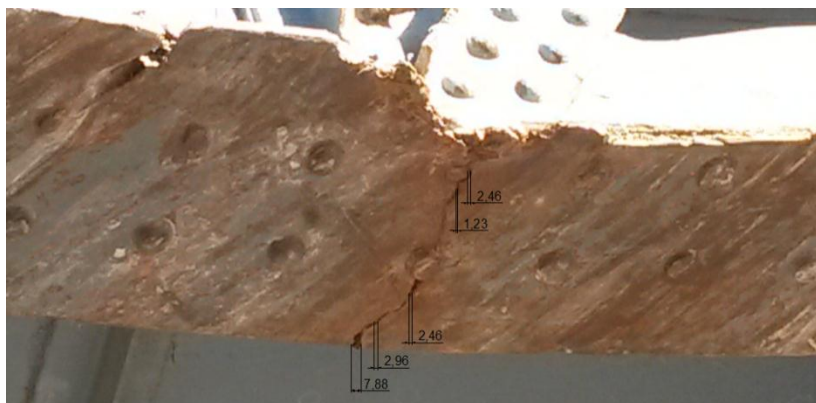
Fissure d'une largeur entre 1,23 et 7,88 mm sur la semelle inferieure de la poutre principale vers Sebdu.
